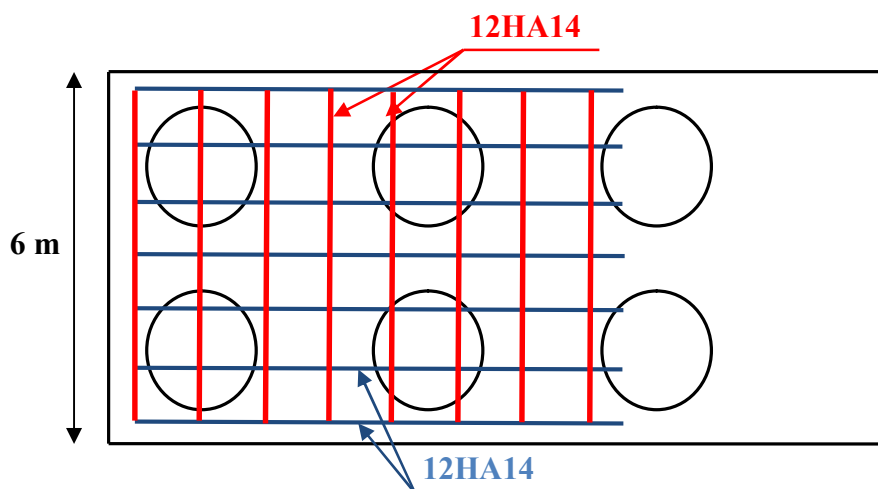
Le ferrailage de la semelle (nappe supérieure).
